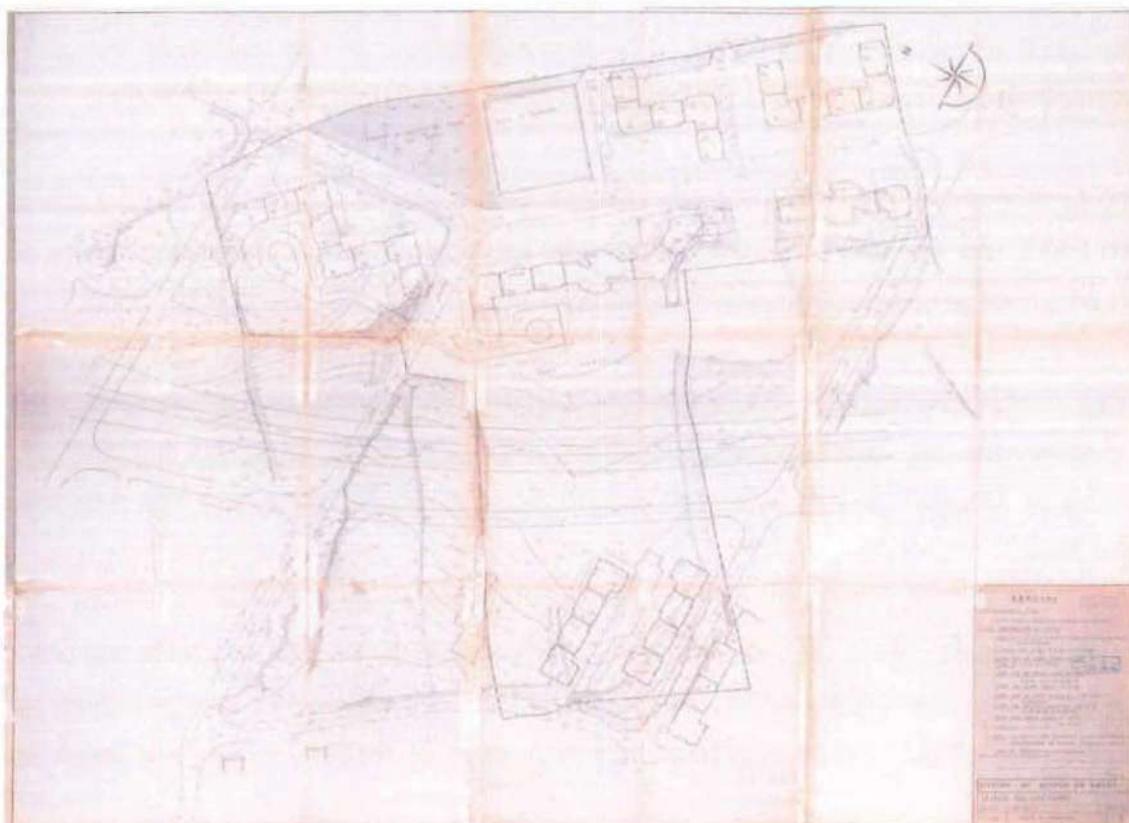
Planta do Loteamento Aprovado, Alvará 5/90
